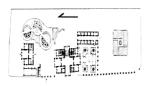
قصر علي باشا بن عون : مسقط أفقي للشكل رقم (١). للطابق الأول (عمل بمعرفه الباحث).
